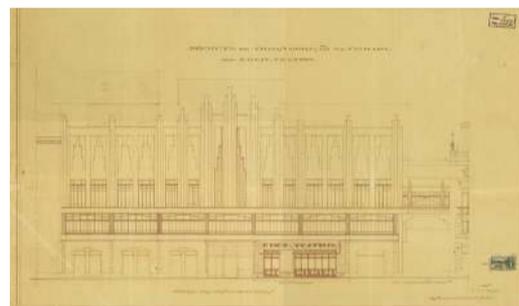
| Desenho da Fachada do Teatro Eden (1929)
